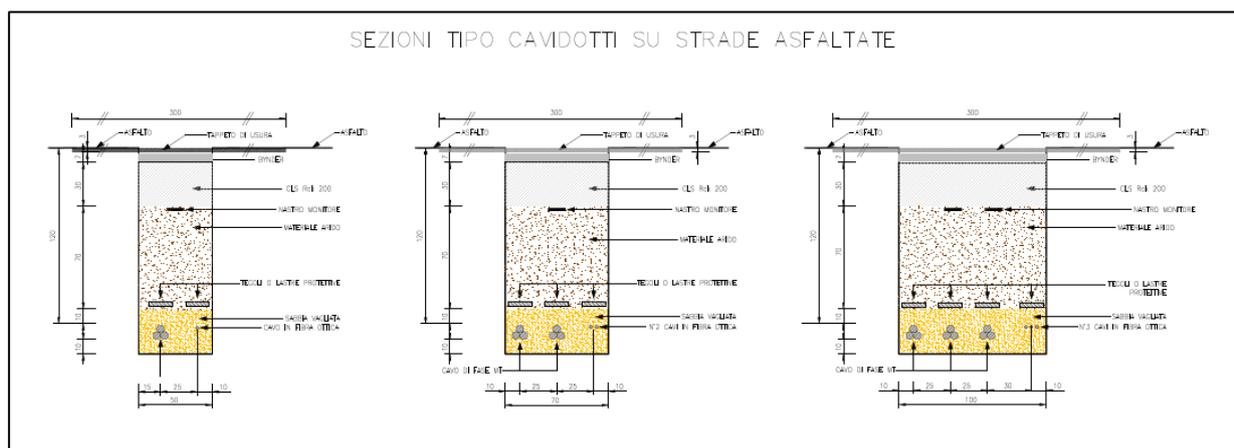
Sezioni tipo Disposizione Cavi MT Su Strade Asfaltate
